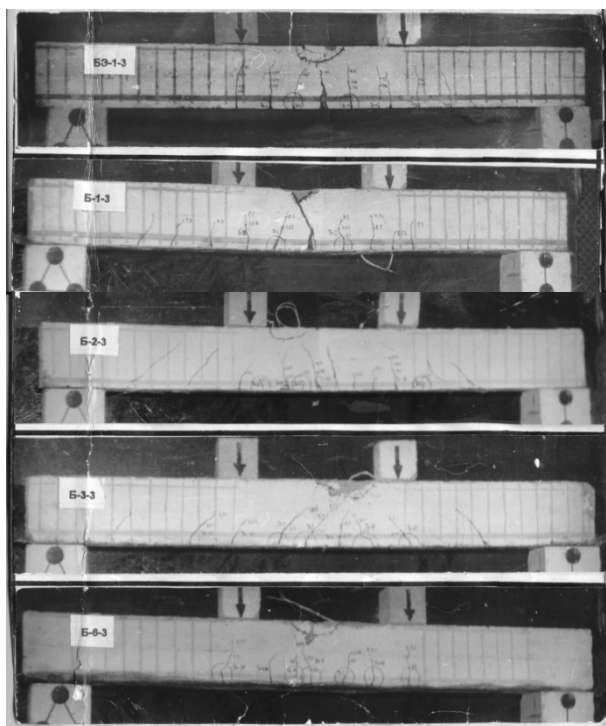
Вид после разрушения опытных балок, усиленных в растянутой зоне внешним композитным армированием
